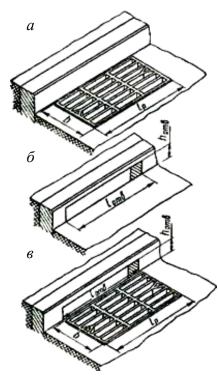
Типы дождеприемников a – с горизонтальным отверстием, перекрытым решеткой; δ – с вертикальным отверстием в плоскости бордюрного камня; ϵ – комбинированные
